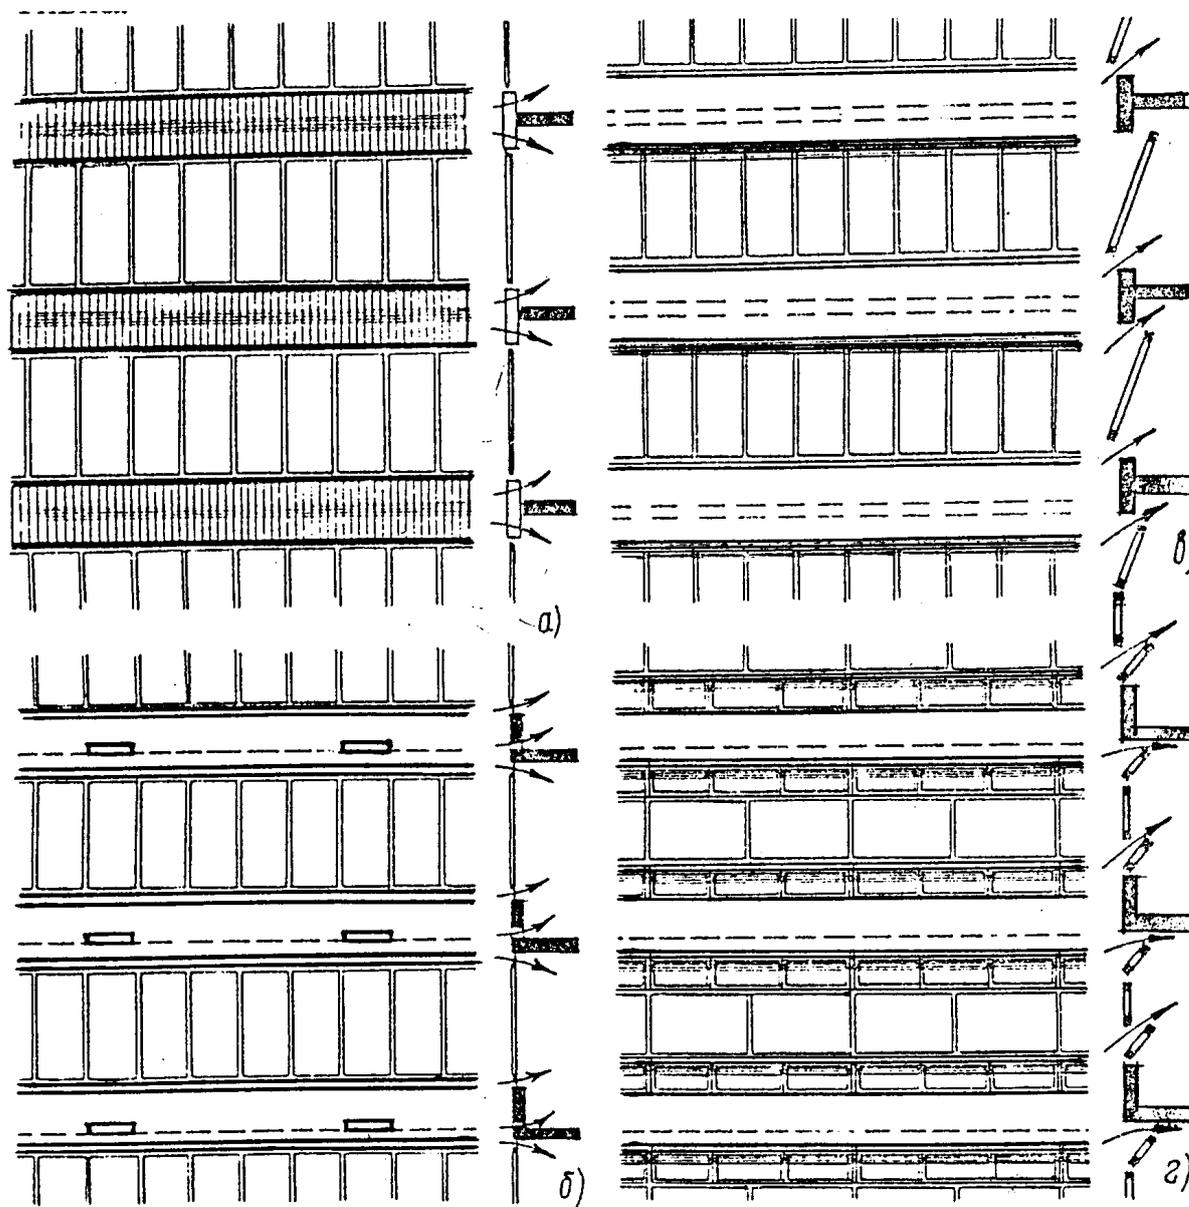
Устройство фасадов, обеспечивающее естественную вентиляцию:
